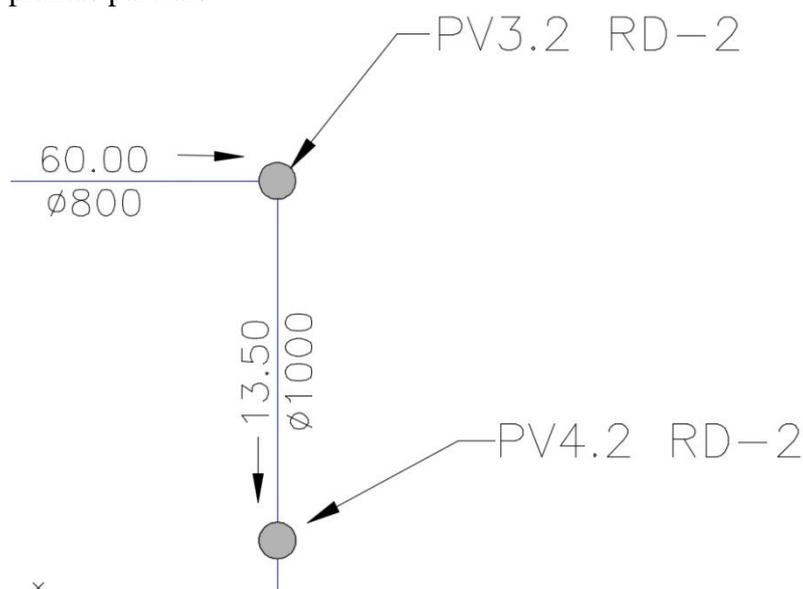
Representação esquemática de um poço de visita – PV na planta geral.
